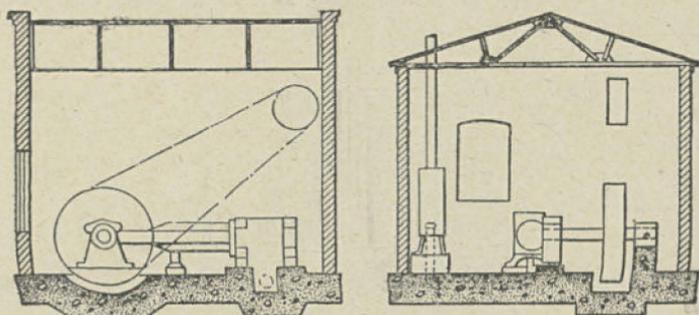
Fondation générale supportant la machine et le bâtiment.
